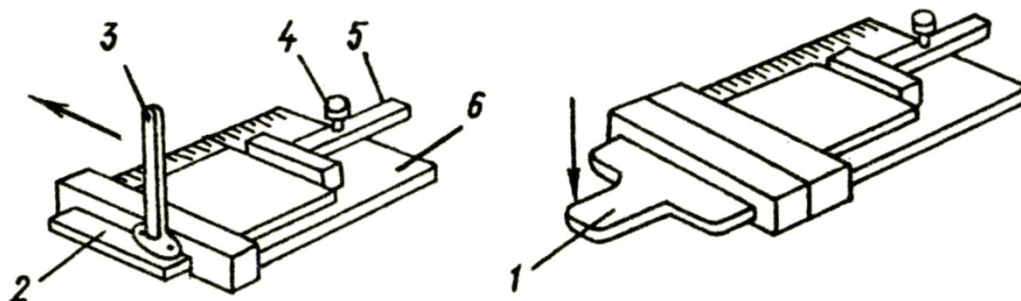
Плиткоріз пластинчастий; 1- плитколом; 2 - керамічна плитка; 3 - різак; 4 - регулювальний гвинт; 5 - упор; 6 - основа
